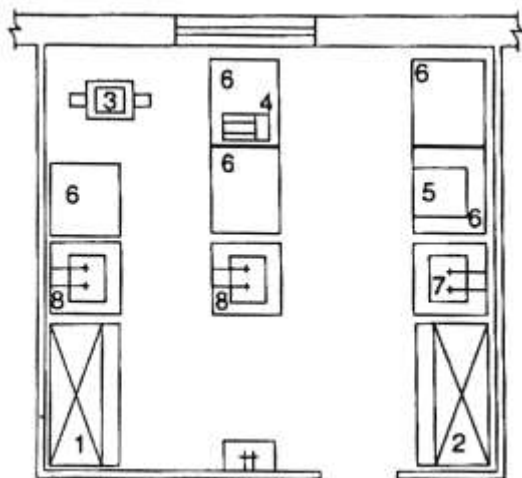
Розміщення обладнання в доготовочному цеху: 1, 2 — холодильні шафи; 3 — механічна м'ясорубка; 4 — розпушувачі; 5 — машина для різання овочів; 6 — виробничий стіл; 7, 8 — мийні ванни.
